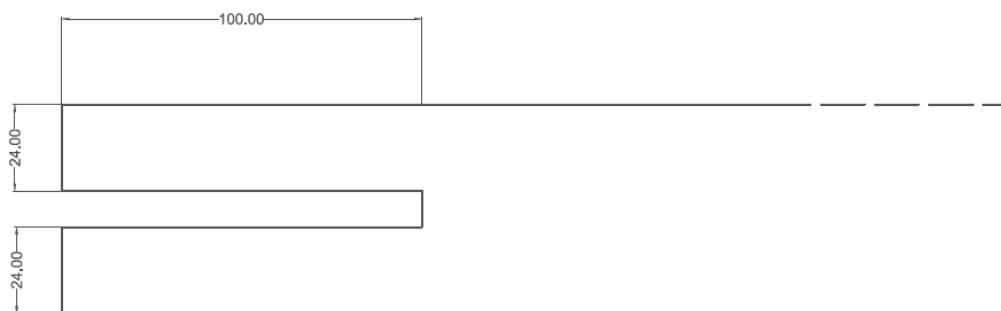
Planta de l'extrem de la biga longitudinal (mesures en mm) - Font pròpia
